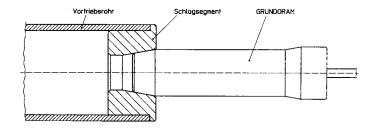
GRUNDORAM avec des casques en butée reliés au tube à pousser
